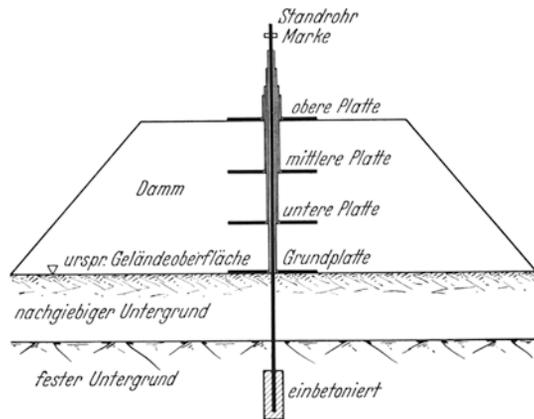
Skizze für den Einbau eines Pegels im Damm und Untergrund.
